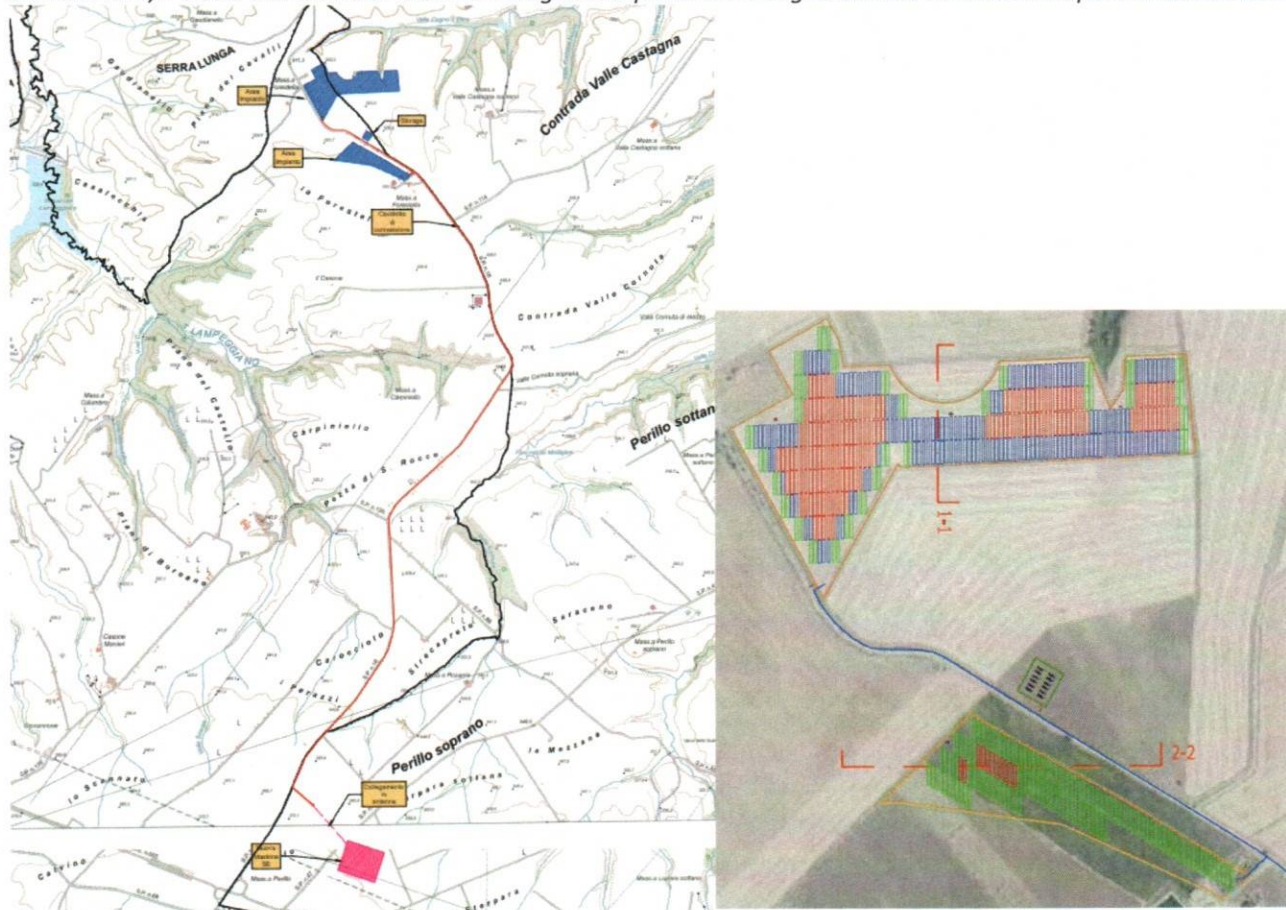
inquadramento dell'impianto, il cavidotto e la stazione elettrica su IGM e Planimetria dell'impianto agrivoltaico sul ortofoto
